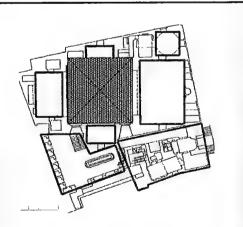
مسقط أفقى مدرسة برسباي [161:200]
